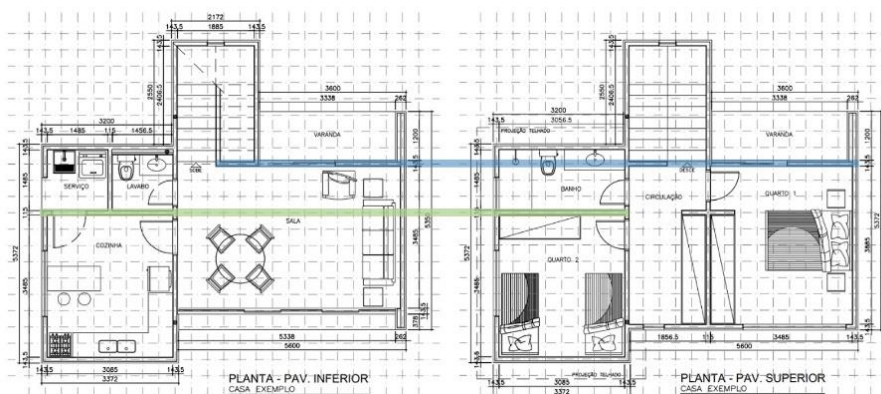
Planta de ambos os pavimentos ajustados para LSF, demonstrando paredes alinhadas após otimização
